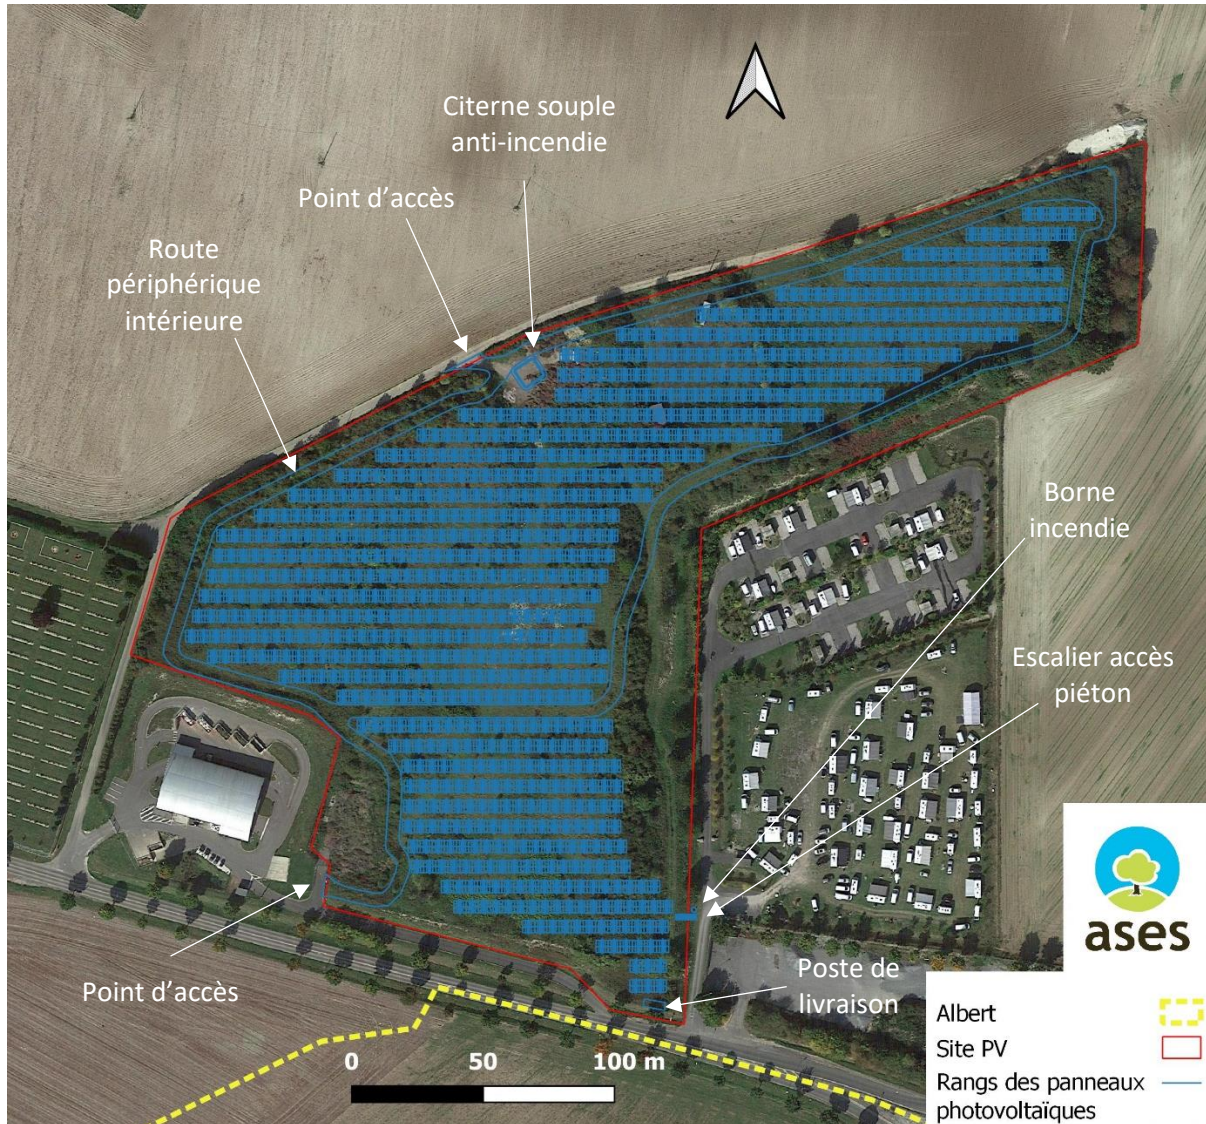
Plan de calepinage du projet sur le site et équipements annexes.
